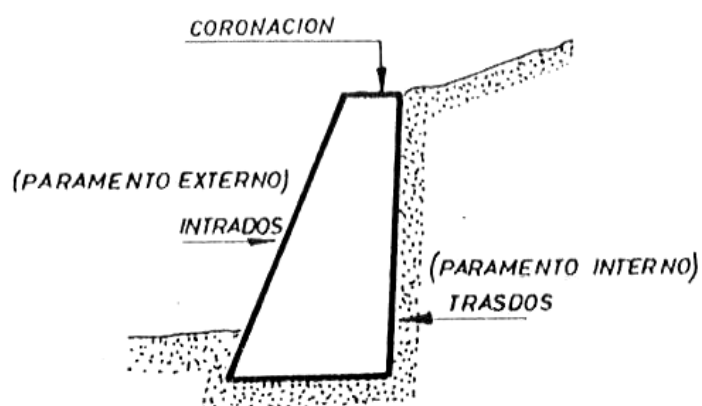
Muro de concreto en masa (Barros; 1974: 13)
